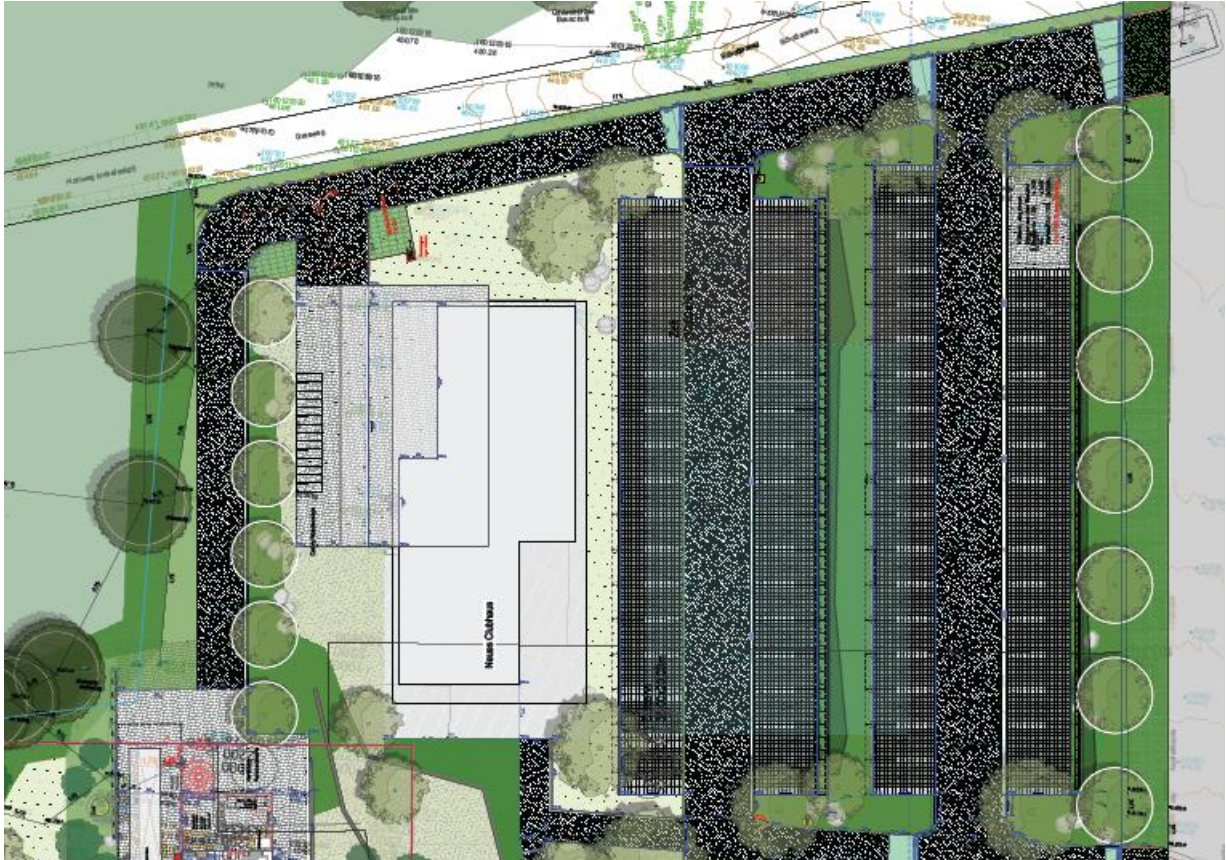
Vorabzug Lageplan der geplanten baulichen Veränderungen – Quelle: FREIRAUM Rabsilber Heckmann Giese Landschaftsarchitekten PartGmbB
